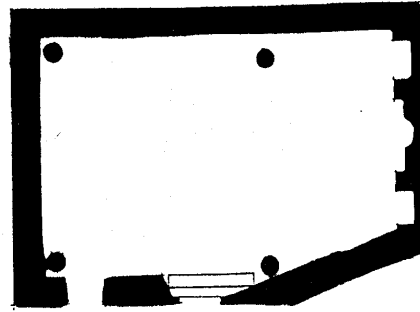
مسقط أفقي لمدفن عبد الوهاب بن مخلوف بمطوبس
